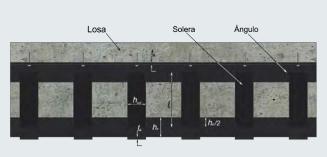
Sección longitudinal de viga encamisada con ángulos y soleras. Fuente: elaboración propia.
